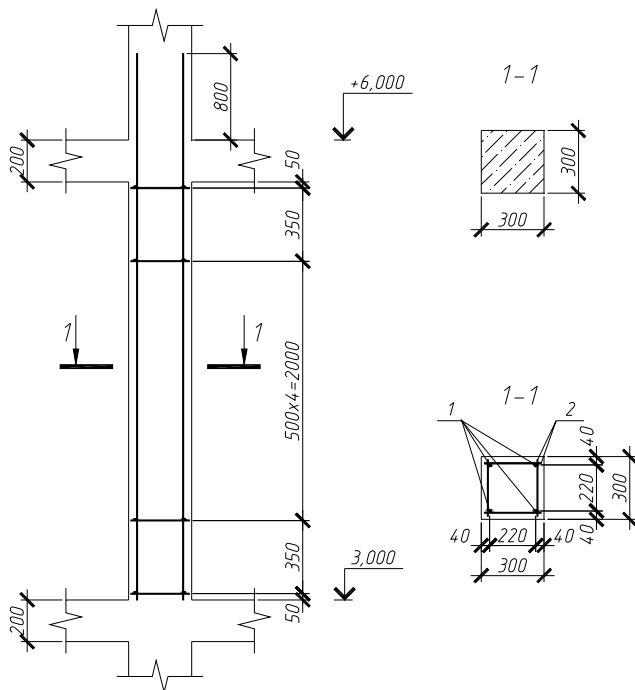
Схема армирования колонны К-1 (к примеру расчета 1)
